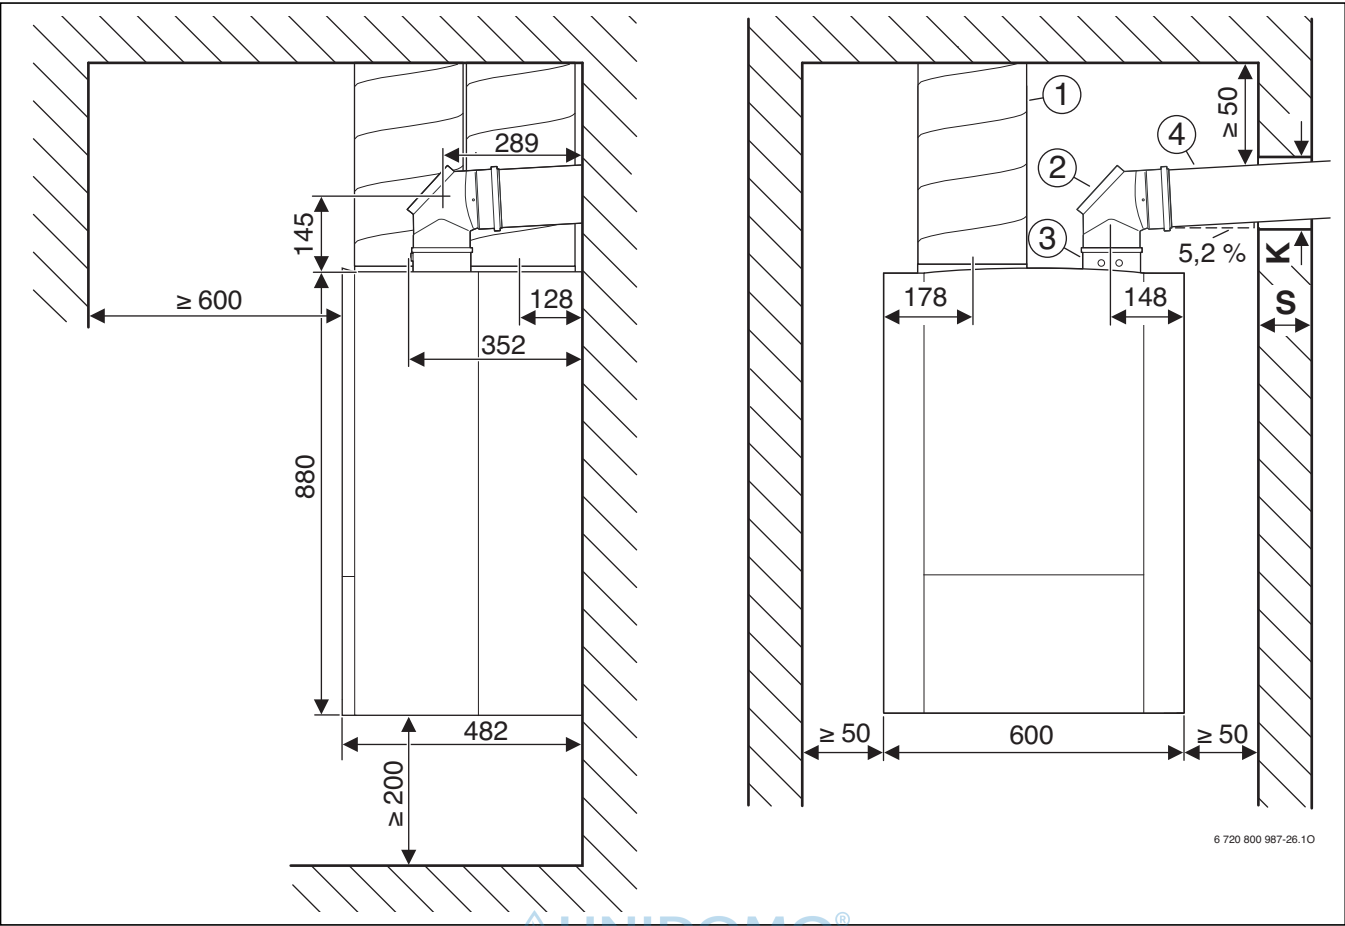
Abgasführung Ø 80/125 mm oder Ø 80 mm
